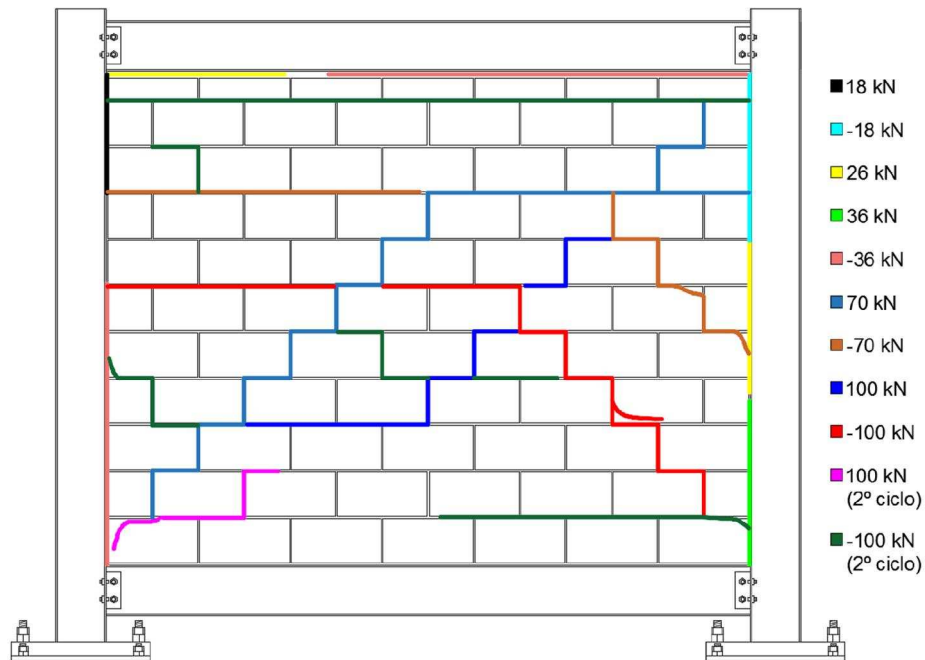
Fissuras - Ensaio PP-3-CE-0.5/2.0
